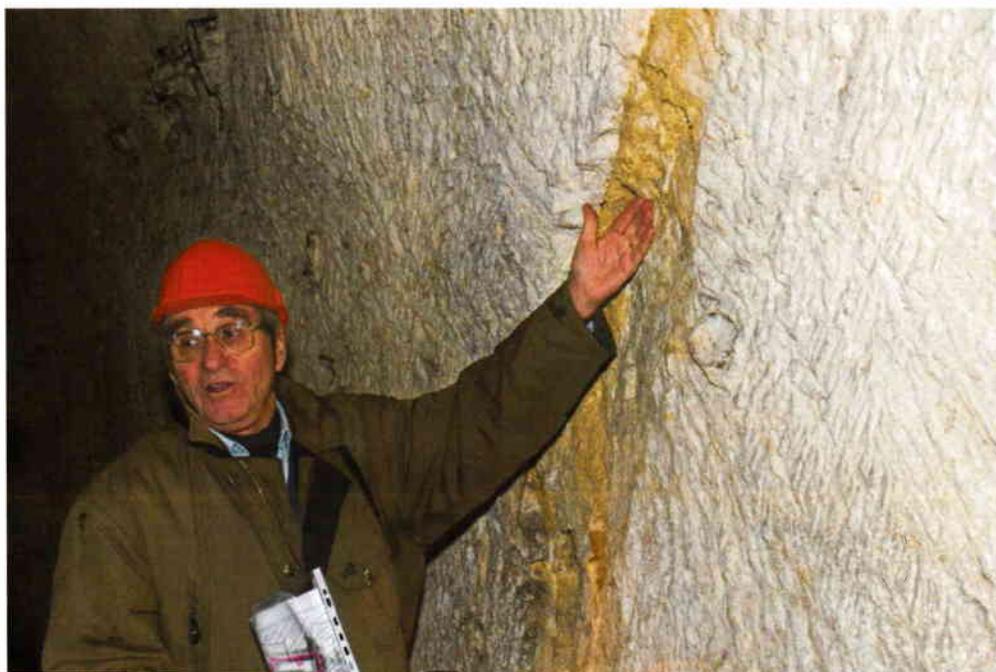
Fissure ouverte dans la craie selon un plan vertical parallèle à la paroi de la galerie (photo B. Cabanis).
